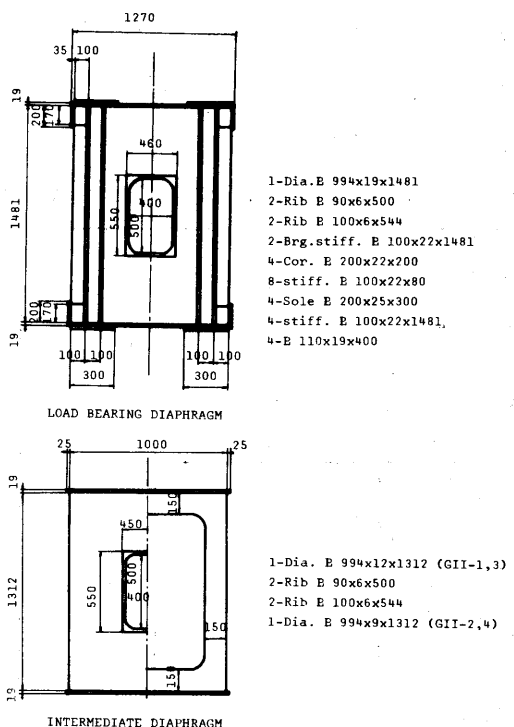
12 DETAILS OF DIAPHRAGMS OF TEST GIRDERS
